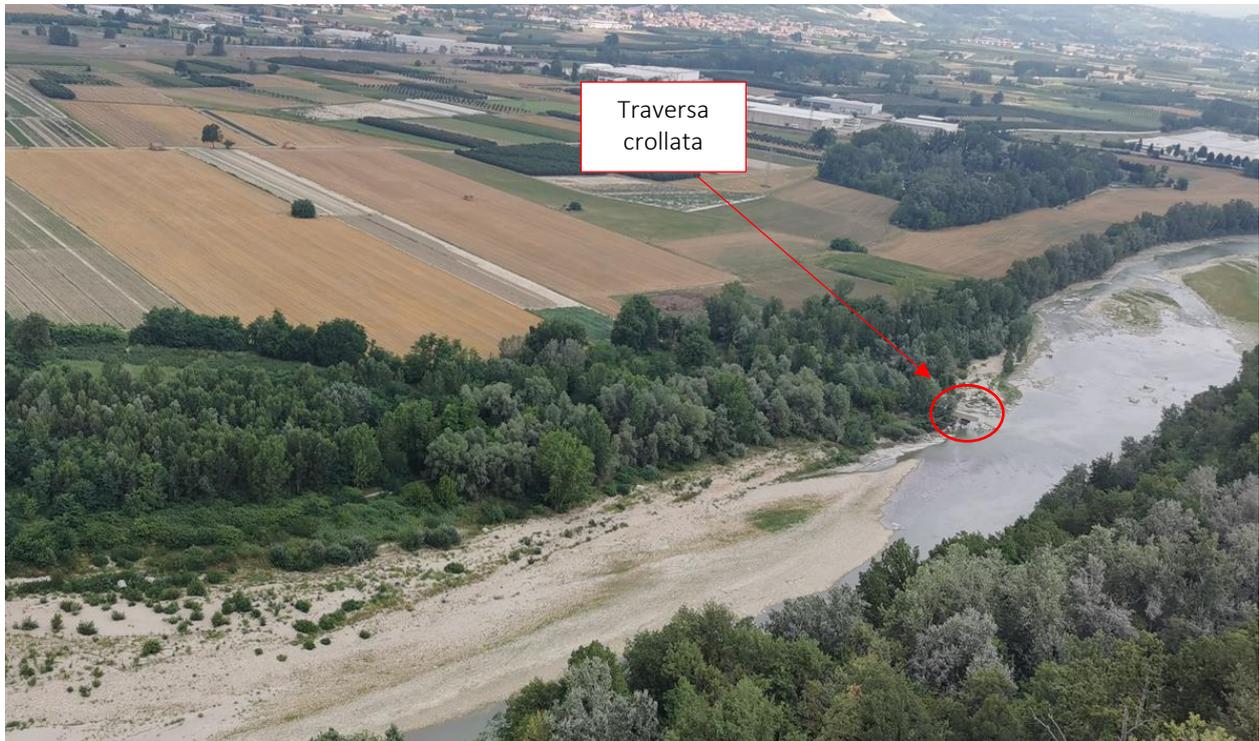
Vista dall'alto della vegetazione in sponda sinistra nel tratto corrispondente all'area d'intervento
